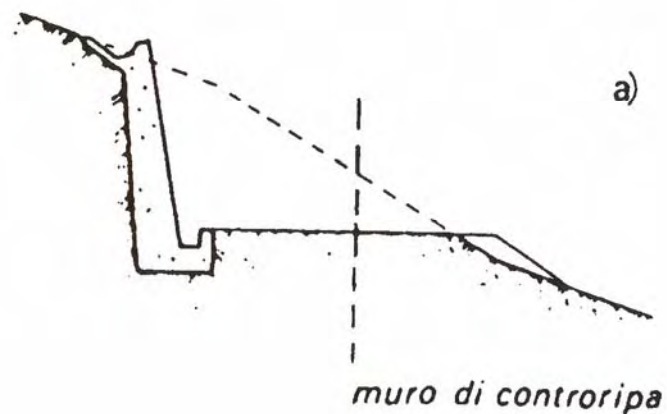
Costruzione di muro di sostegno per sezione stradale in trincea
